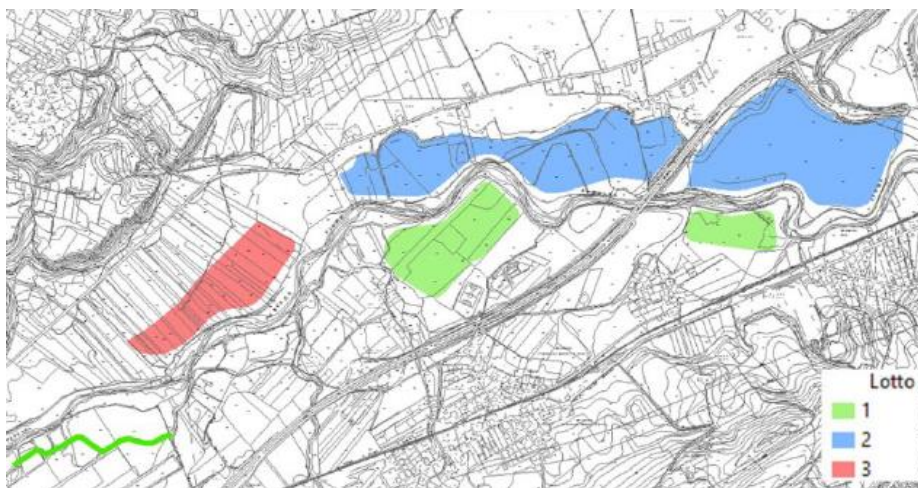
Planimetria dell'intervento con evidenziata la suddivisione in lotti funzionali.
